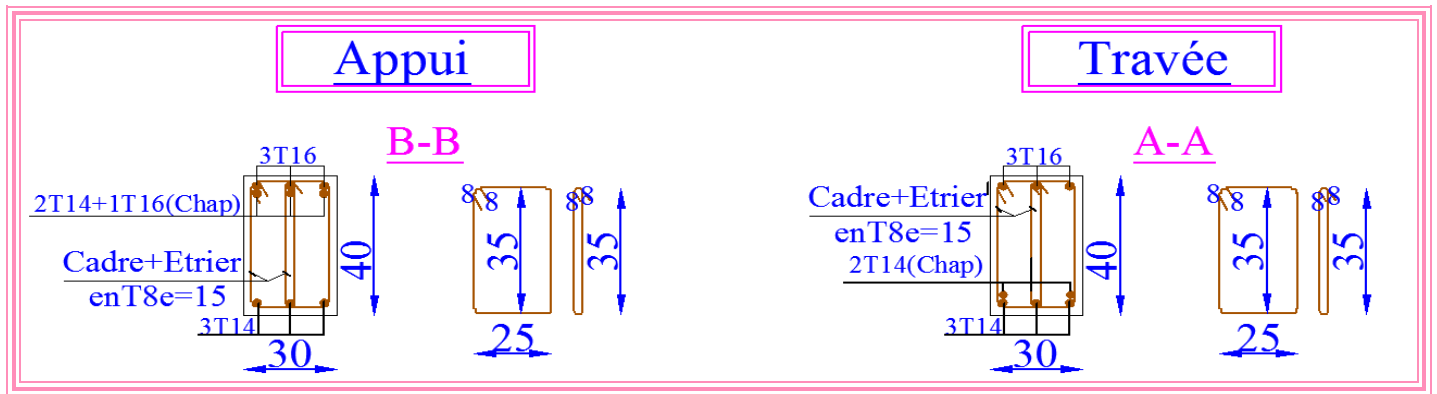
Schéma de dispositions constructives avec la coupe en travée et appui de la poutre principale et secondaire de l'étage courant non associée aux voiles
